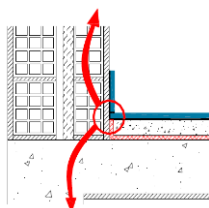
Erro de colocação da banda resiliente em pavimentos, criando um ponto de passagem de ruído (Mateus & Pereira, 2011)
